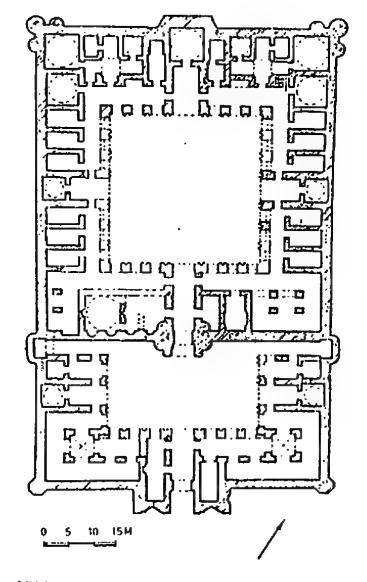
مسقط أفقى لخان ،كرتلوتبه شهر، (عن آصلان آبا).
